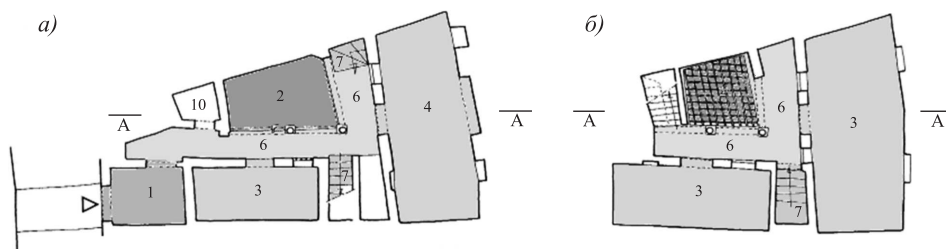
План первого (а) и второго (б) этажа дома «Чебек»
